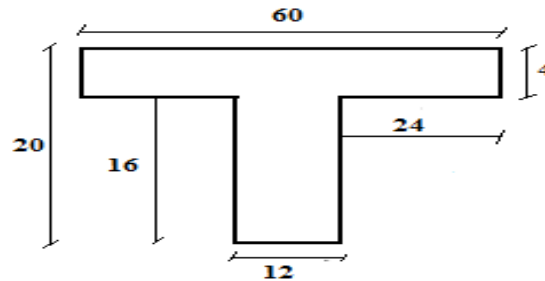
Schéma de la poutrelle après le coulage de la table.
